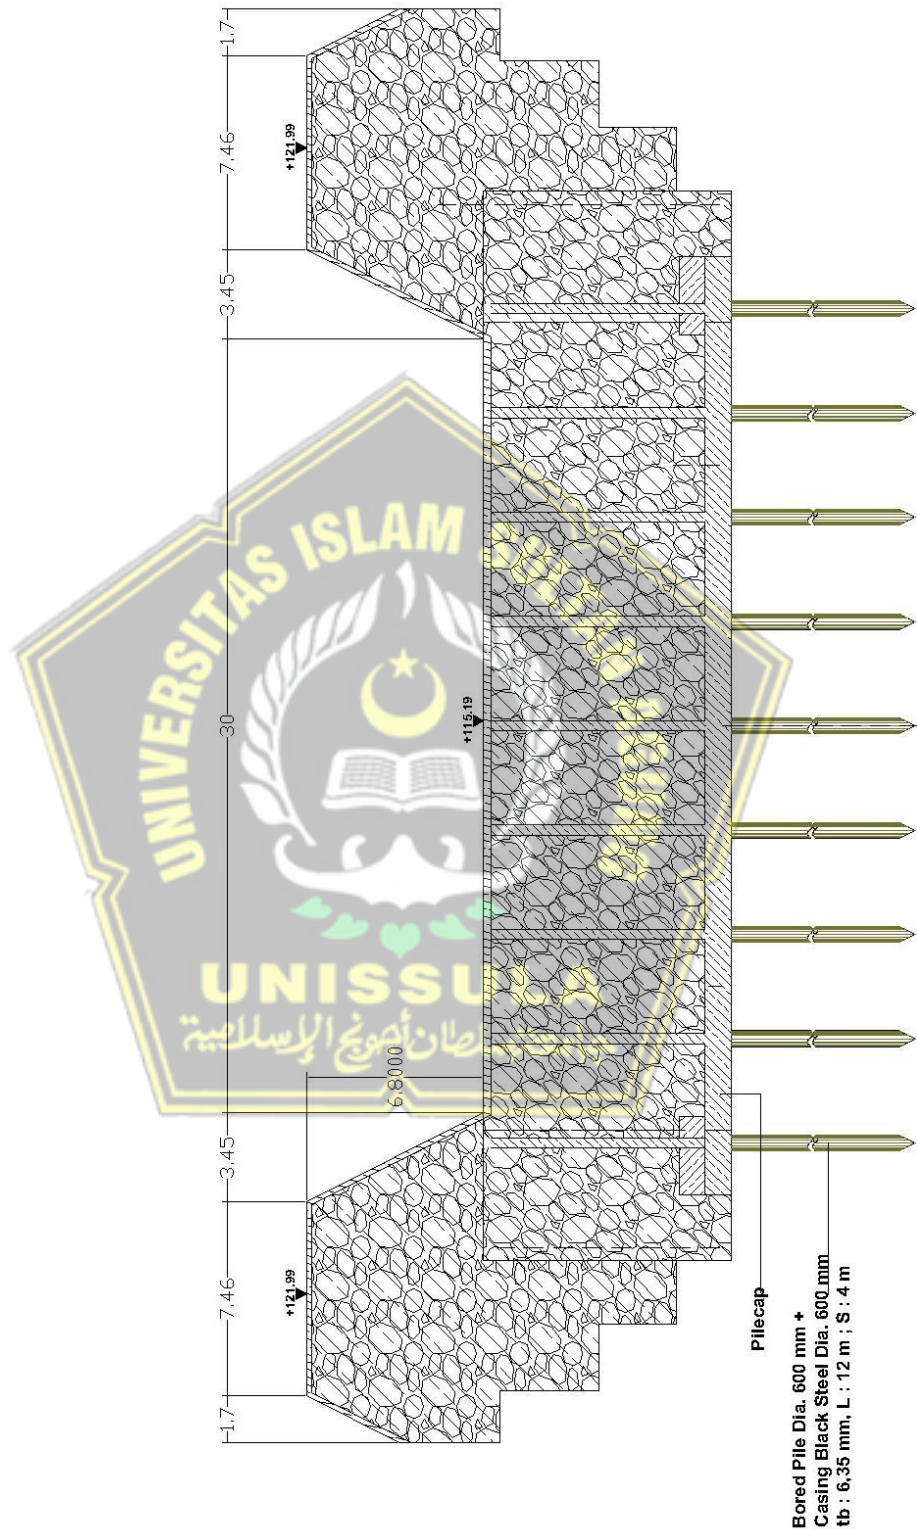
Denah situasi *Groundsill* DI Gunung
